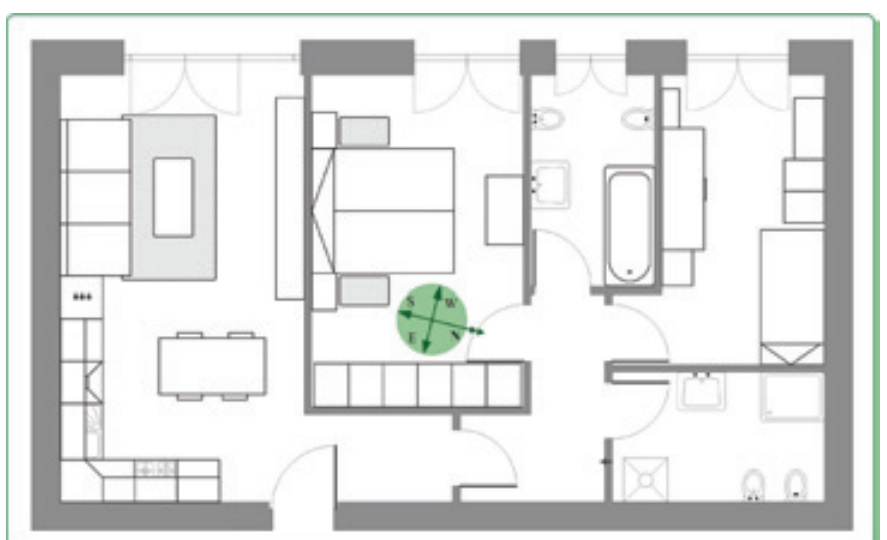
Planimetria dell'appartamento considerato come esempio.
